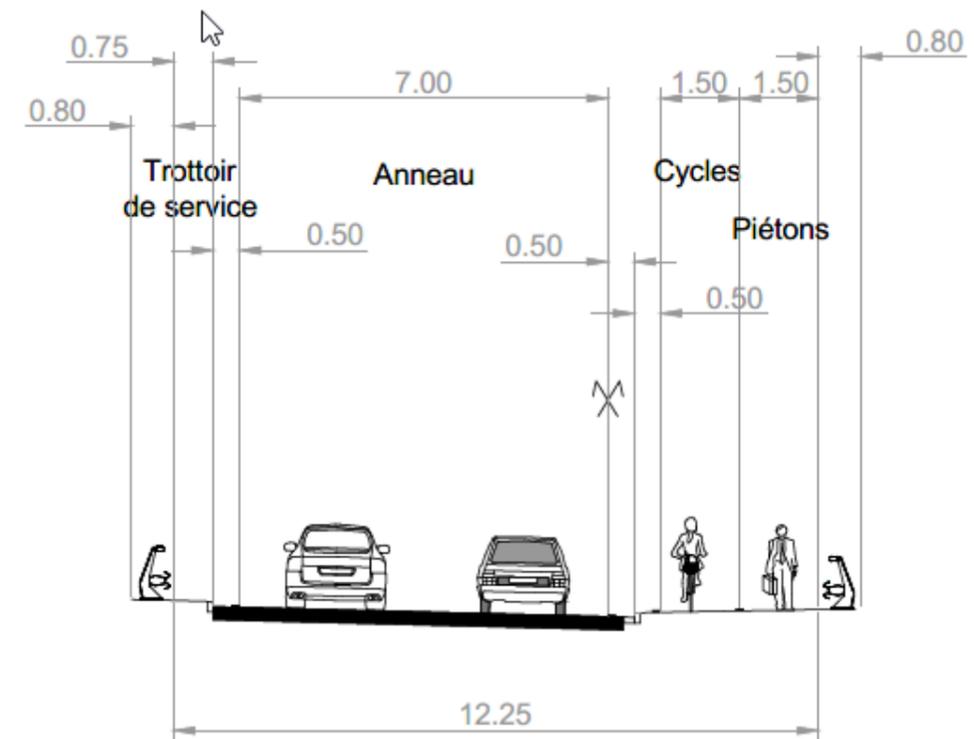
Profil en travers type sur ouvrage giratoire dénivelé
